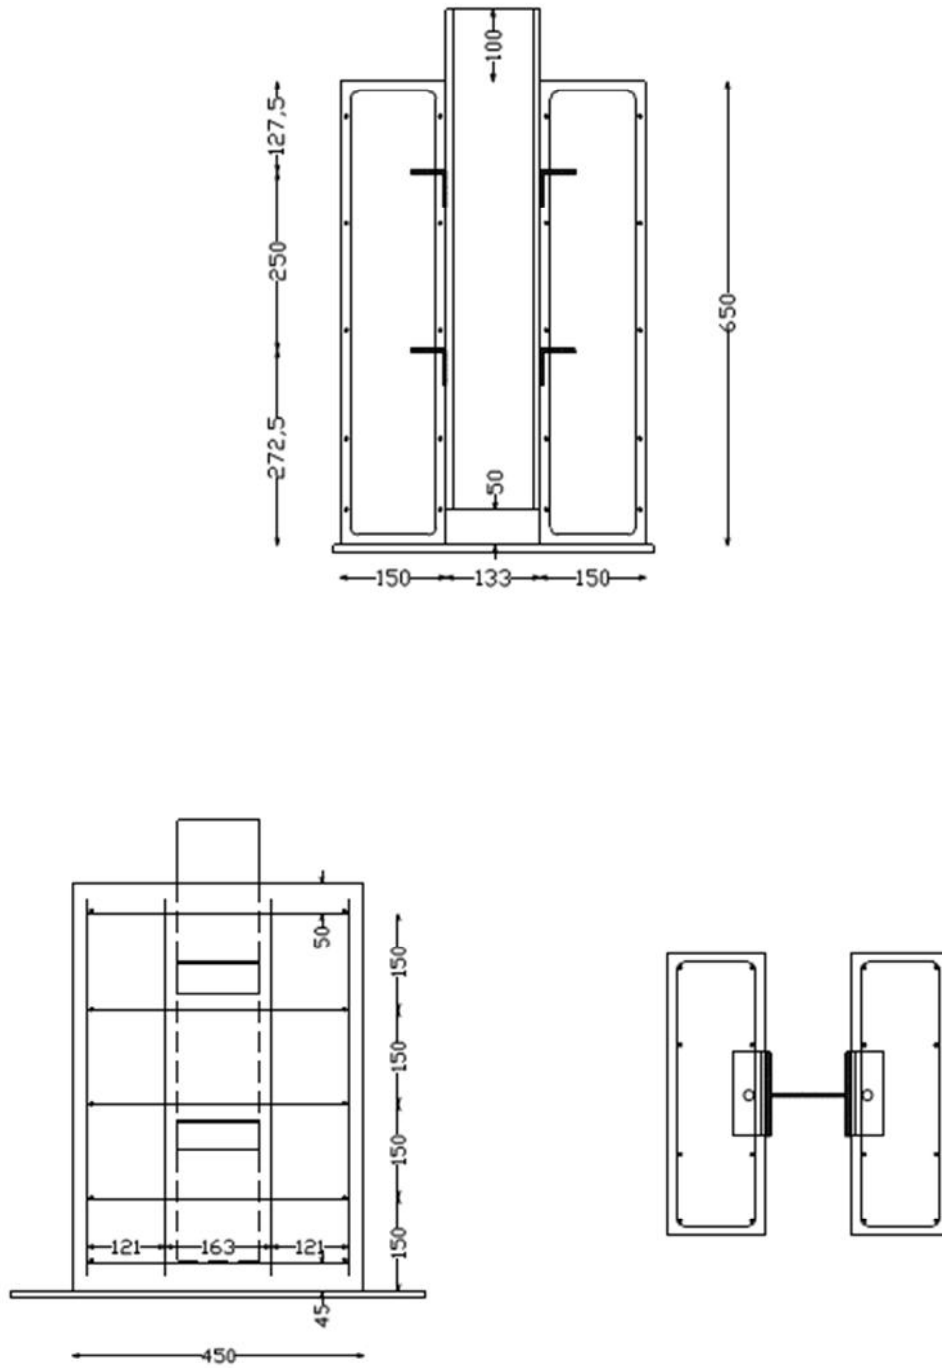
Eprouvette d'essai Push Out –cas de connecteur en cornière.
